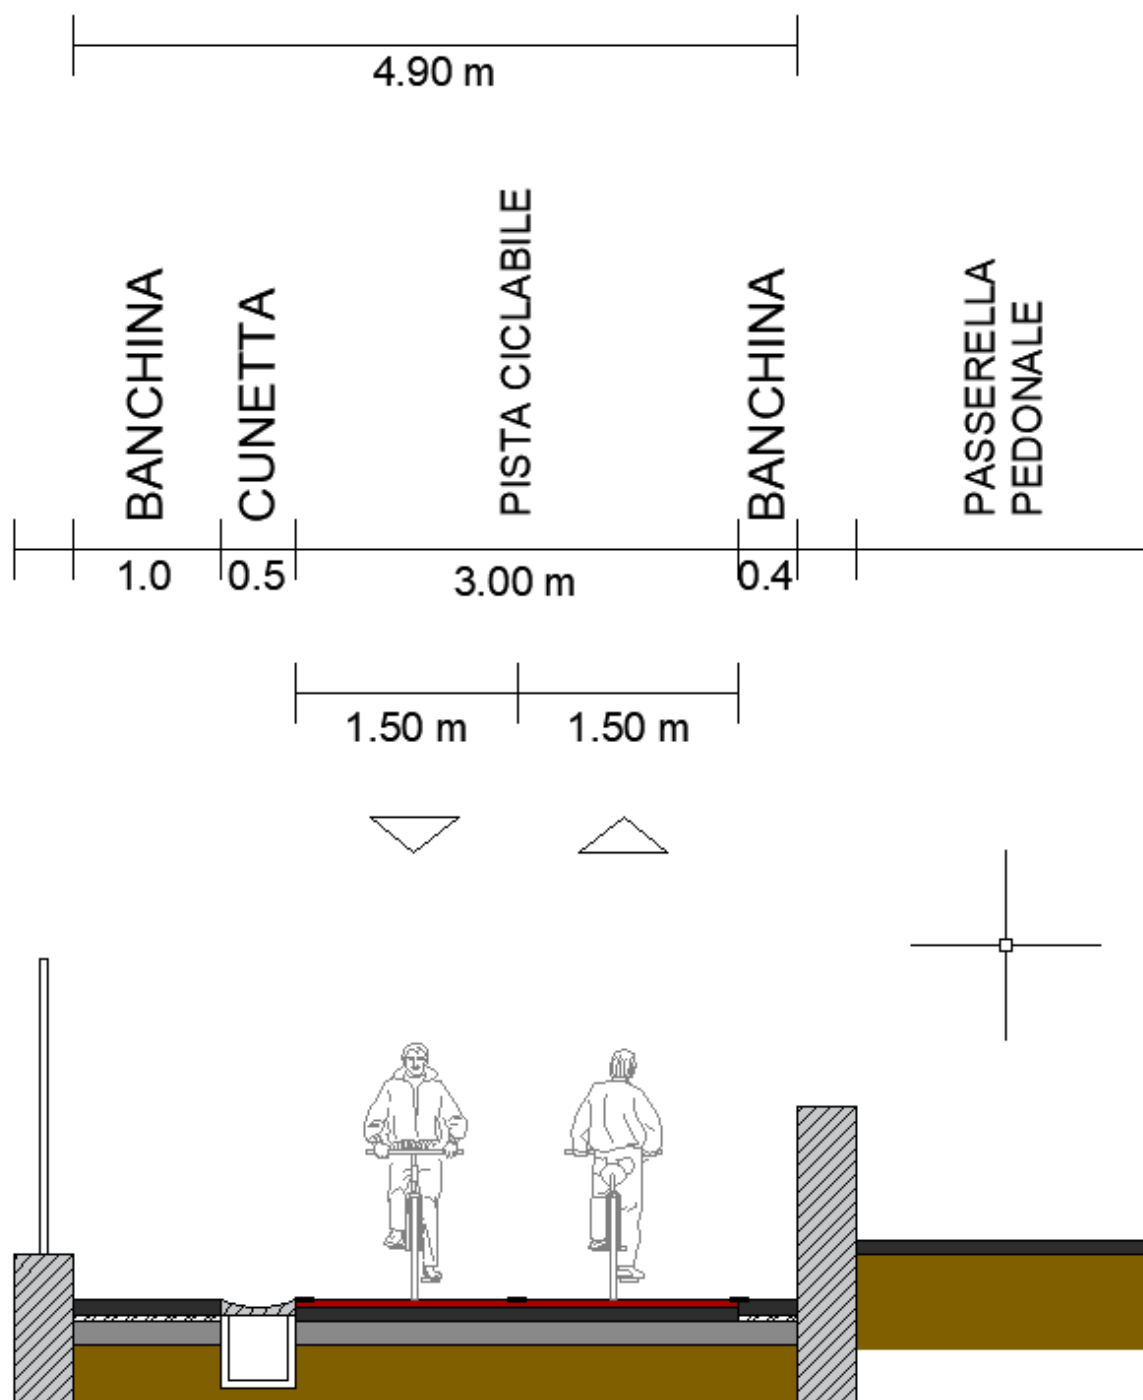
via Claudio – tratto finale, sezione trasversale di progetto (sez. C di Fig. 12.6).
